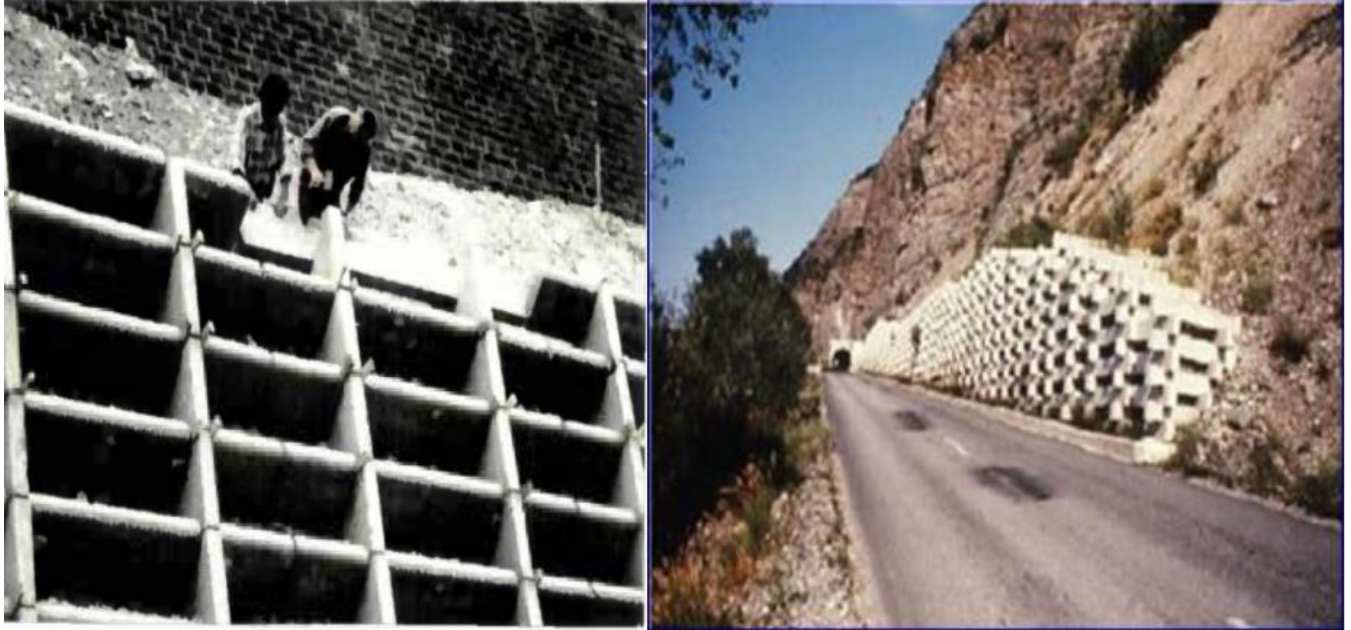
Mur en éléments préfabriqués en béton empilés
